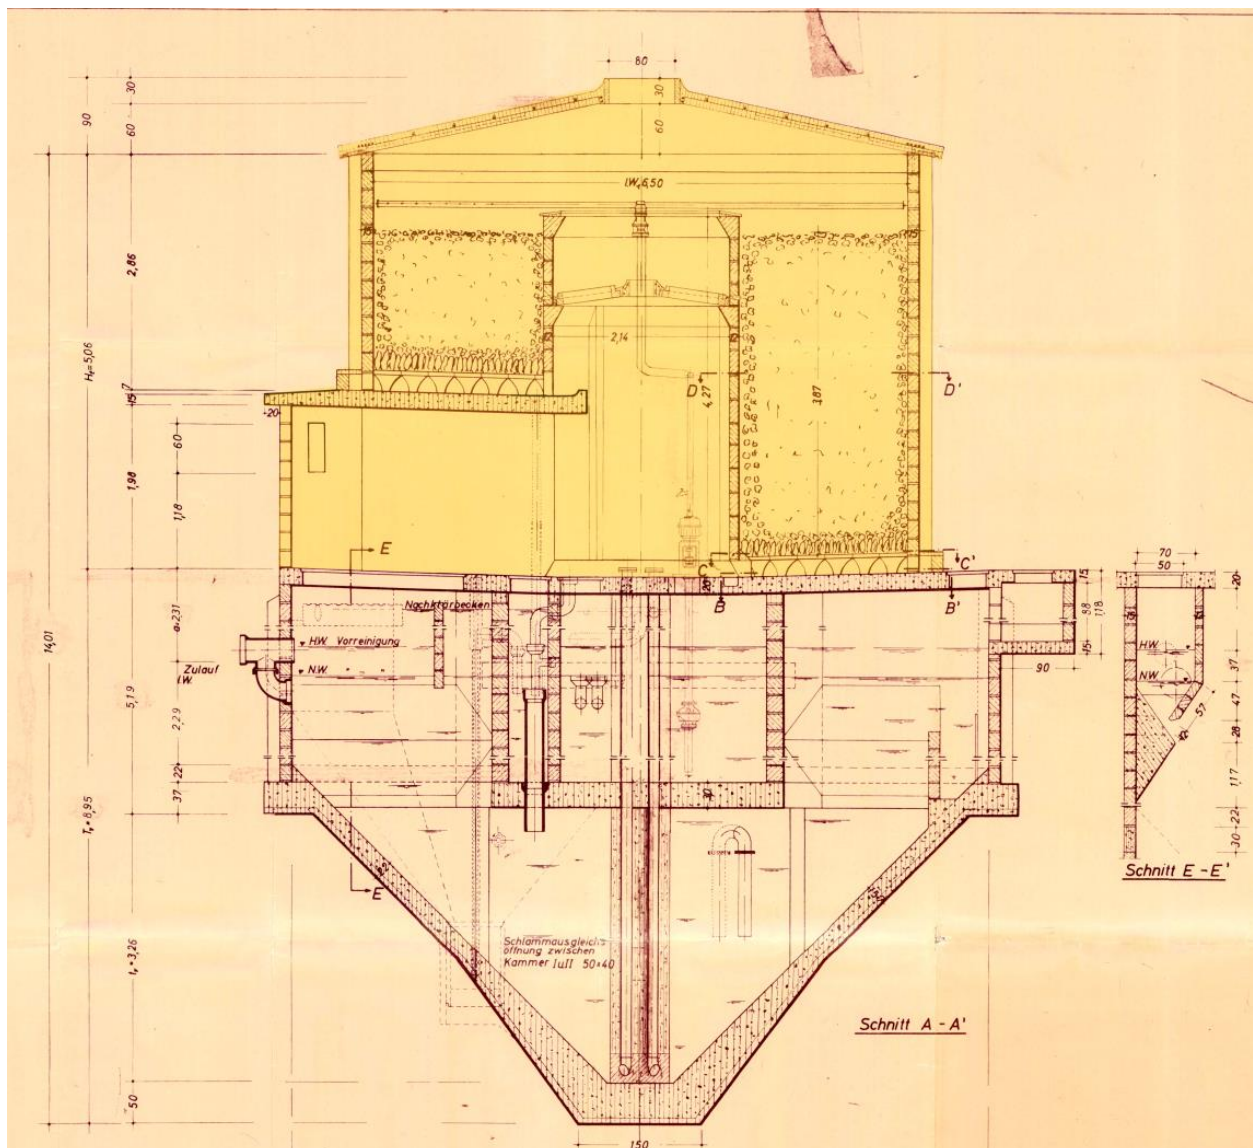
Schnitt - Ausschnitt aus Bestandsplan Tropfkörper KA Sandkamp. Die Gebäude wurden laut Aussage des AG baugleich ausgeführt, Rückbau ist gelb markiert
